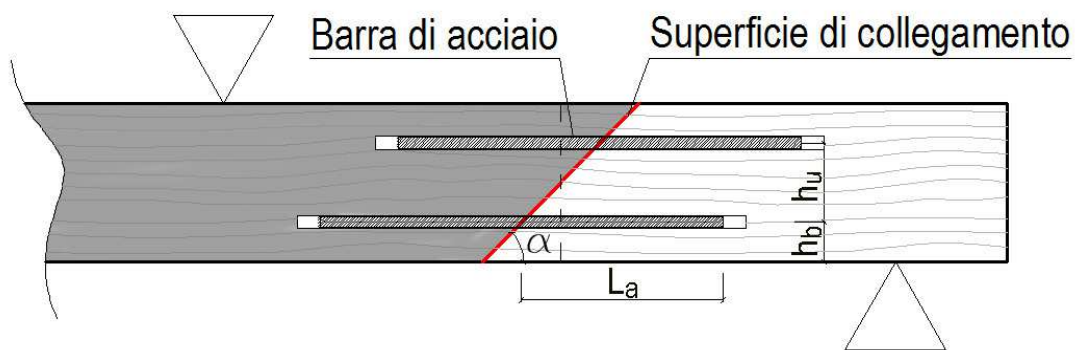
Rappresentazione schematica del giunto in sezione longitudinale, con evidenziata la superficie di collegamento fra la parte di trave sana e la protesi.
